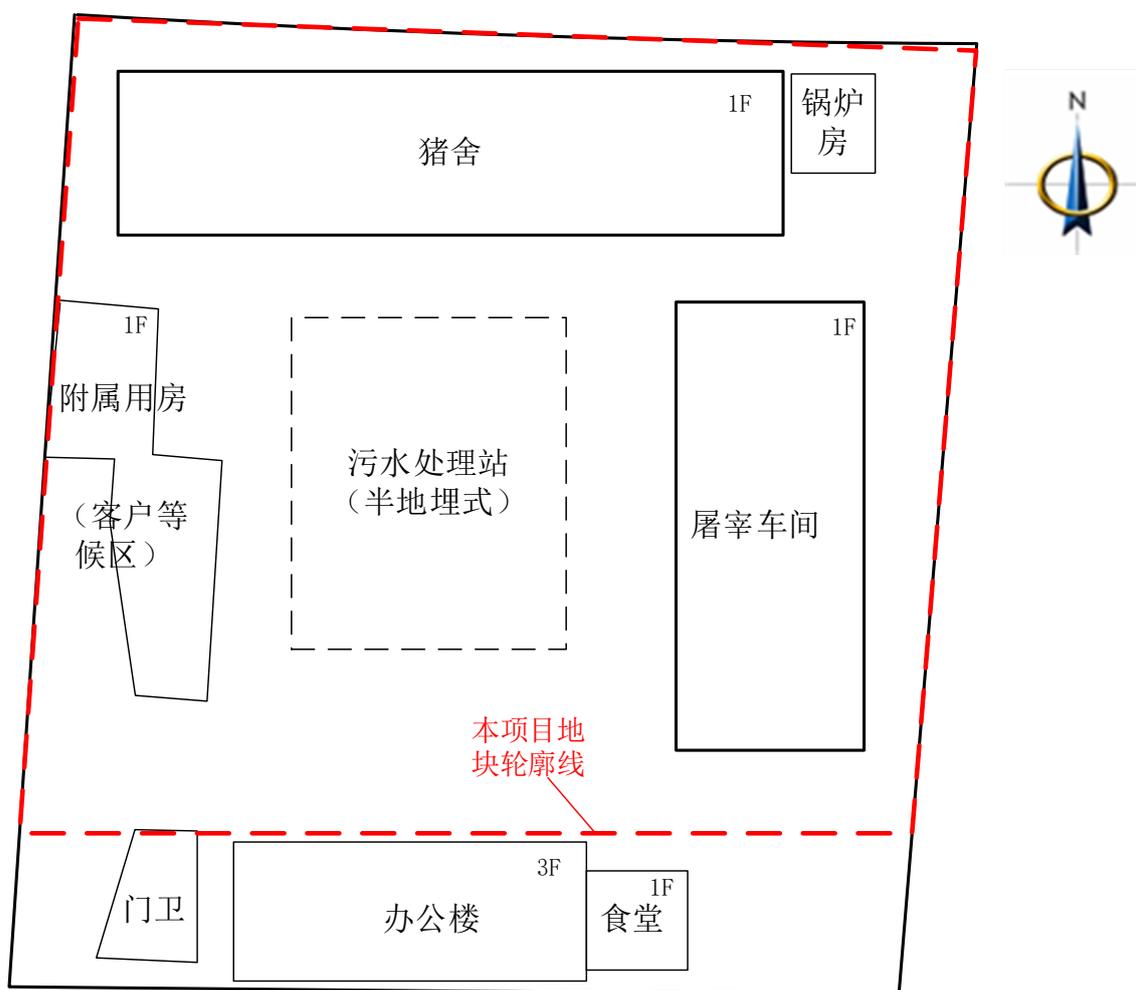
未拆除前花桥生猪定点屠宰场平面布置图
